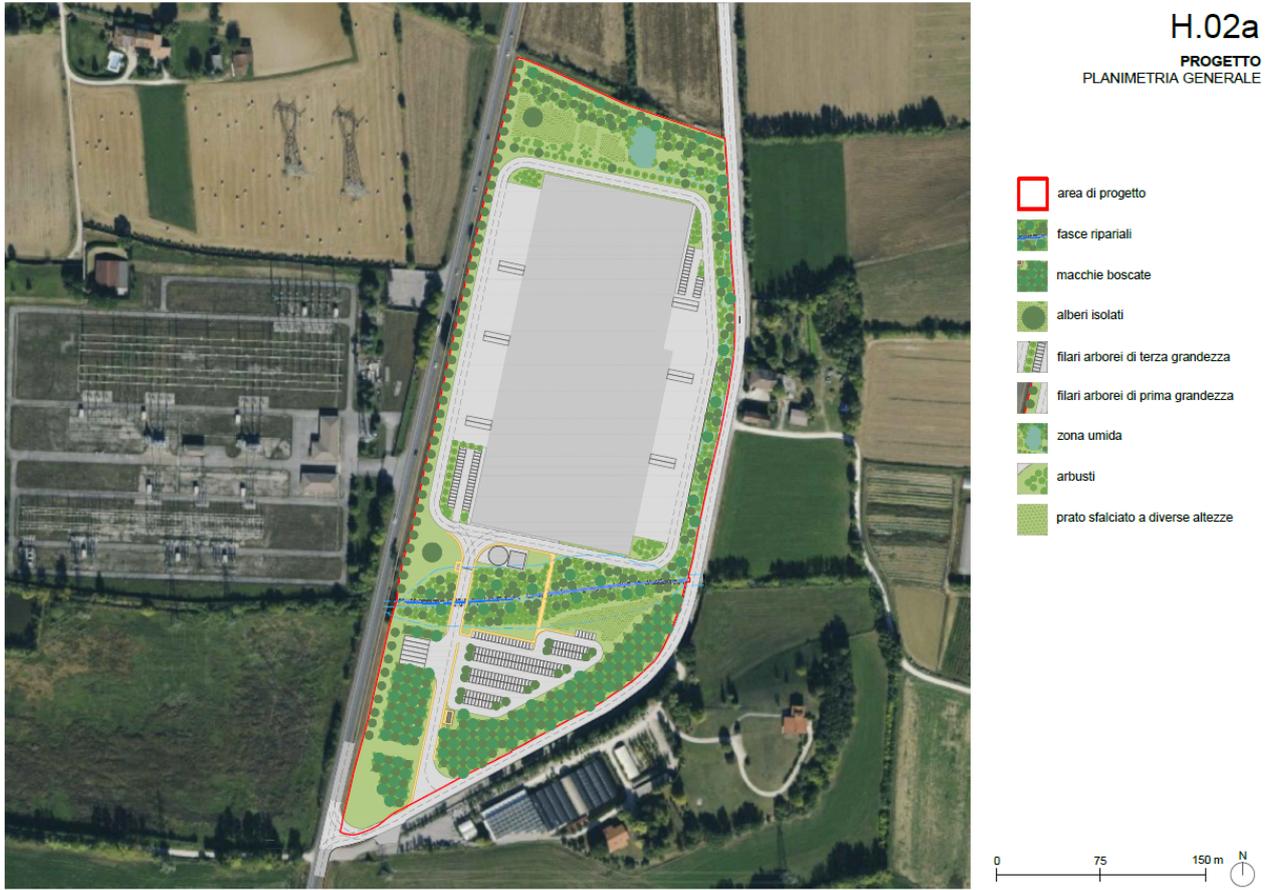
Planimetria Generale di progetto (fonte: elaborato H.02a)
